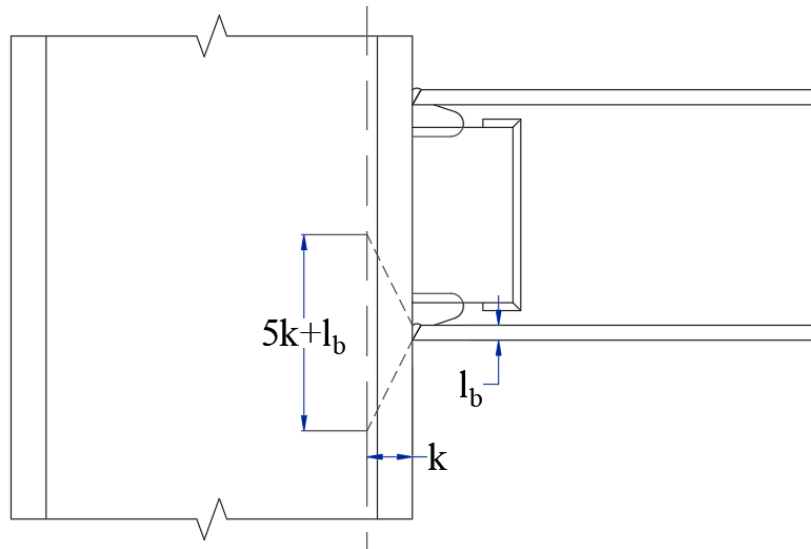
Esquema k , l_b de conexión (elaborado por el autor)
